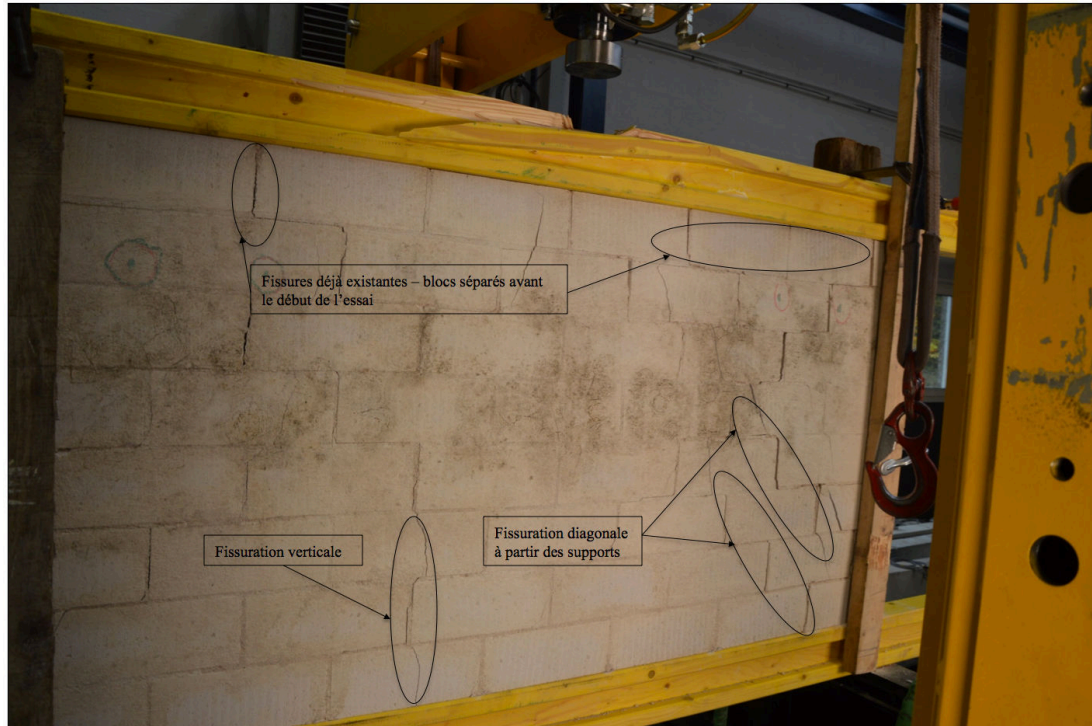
Illustration du mur F5 à la fin de l'essai: fissurations partout dans le mur
